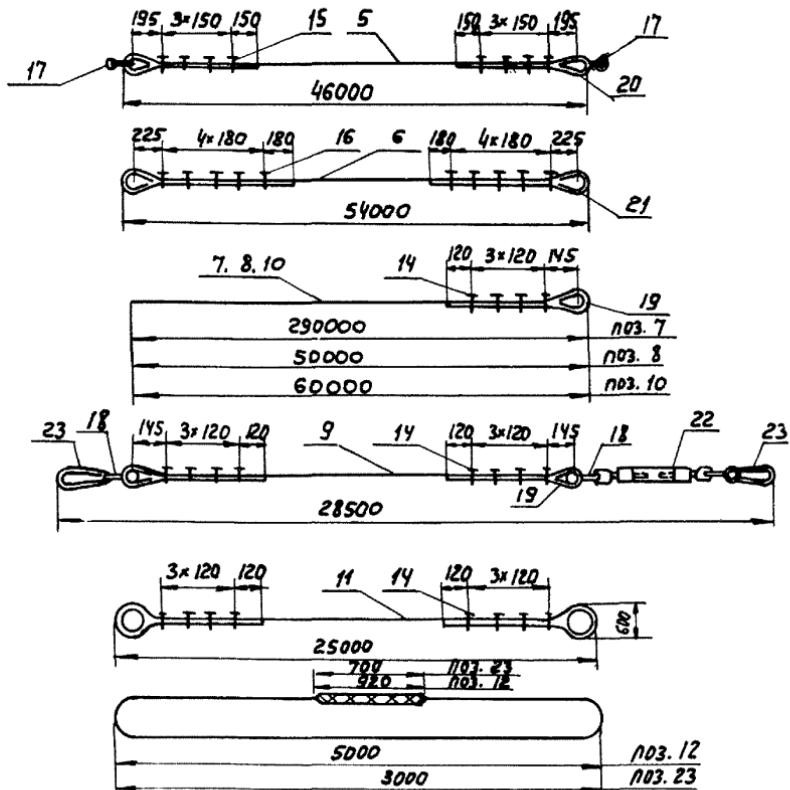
Детали строповки опор НБ-500-2; НБ-500-3.
